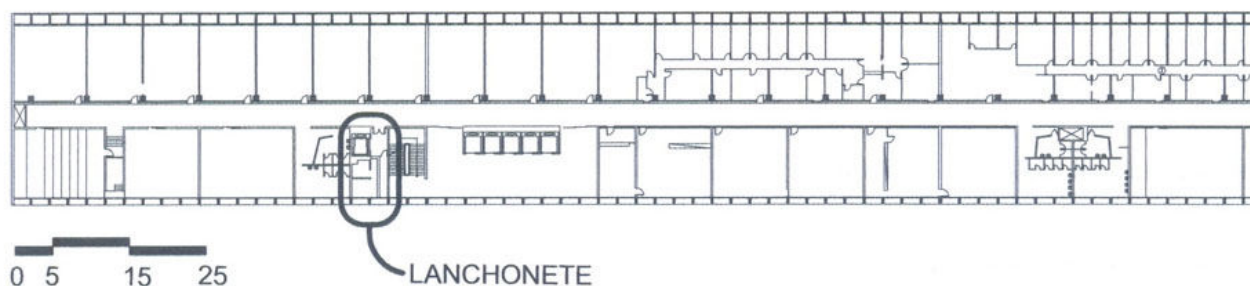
Planta baixa do 5º pavimento - Edifício da FAU, EBA e Reitoria da UFRJ
